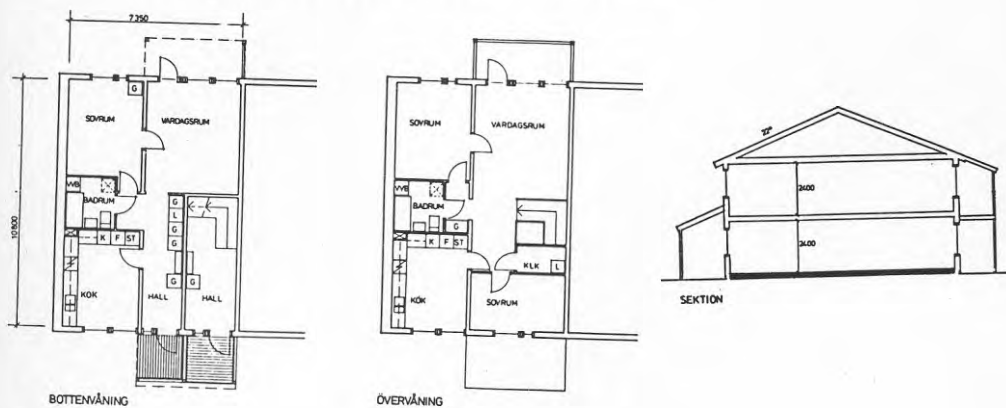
Betongbyggdelar i alternativ 1 och 2.
